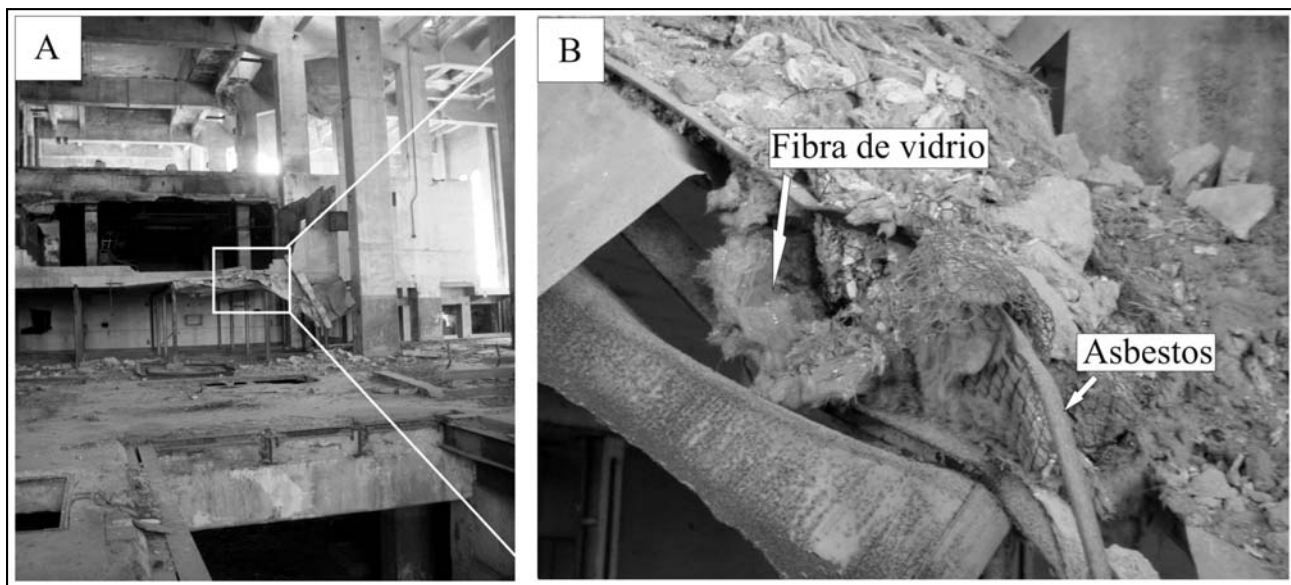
A. Cielorraso caído en la planta alta del edificio. B. Detalle del techo, donde se observa los materiales aislantes fibrosos.
